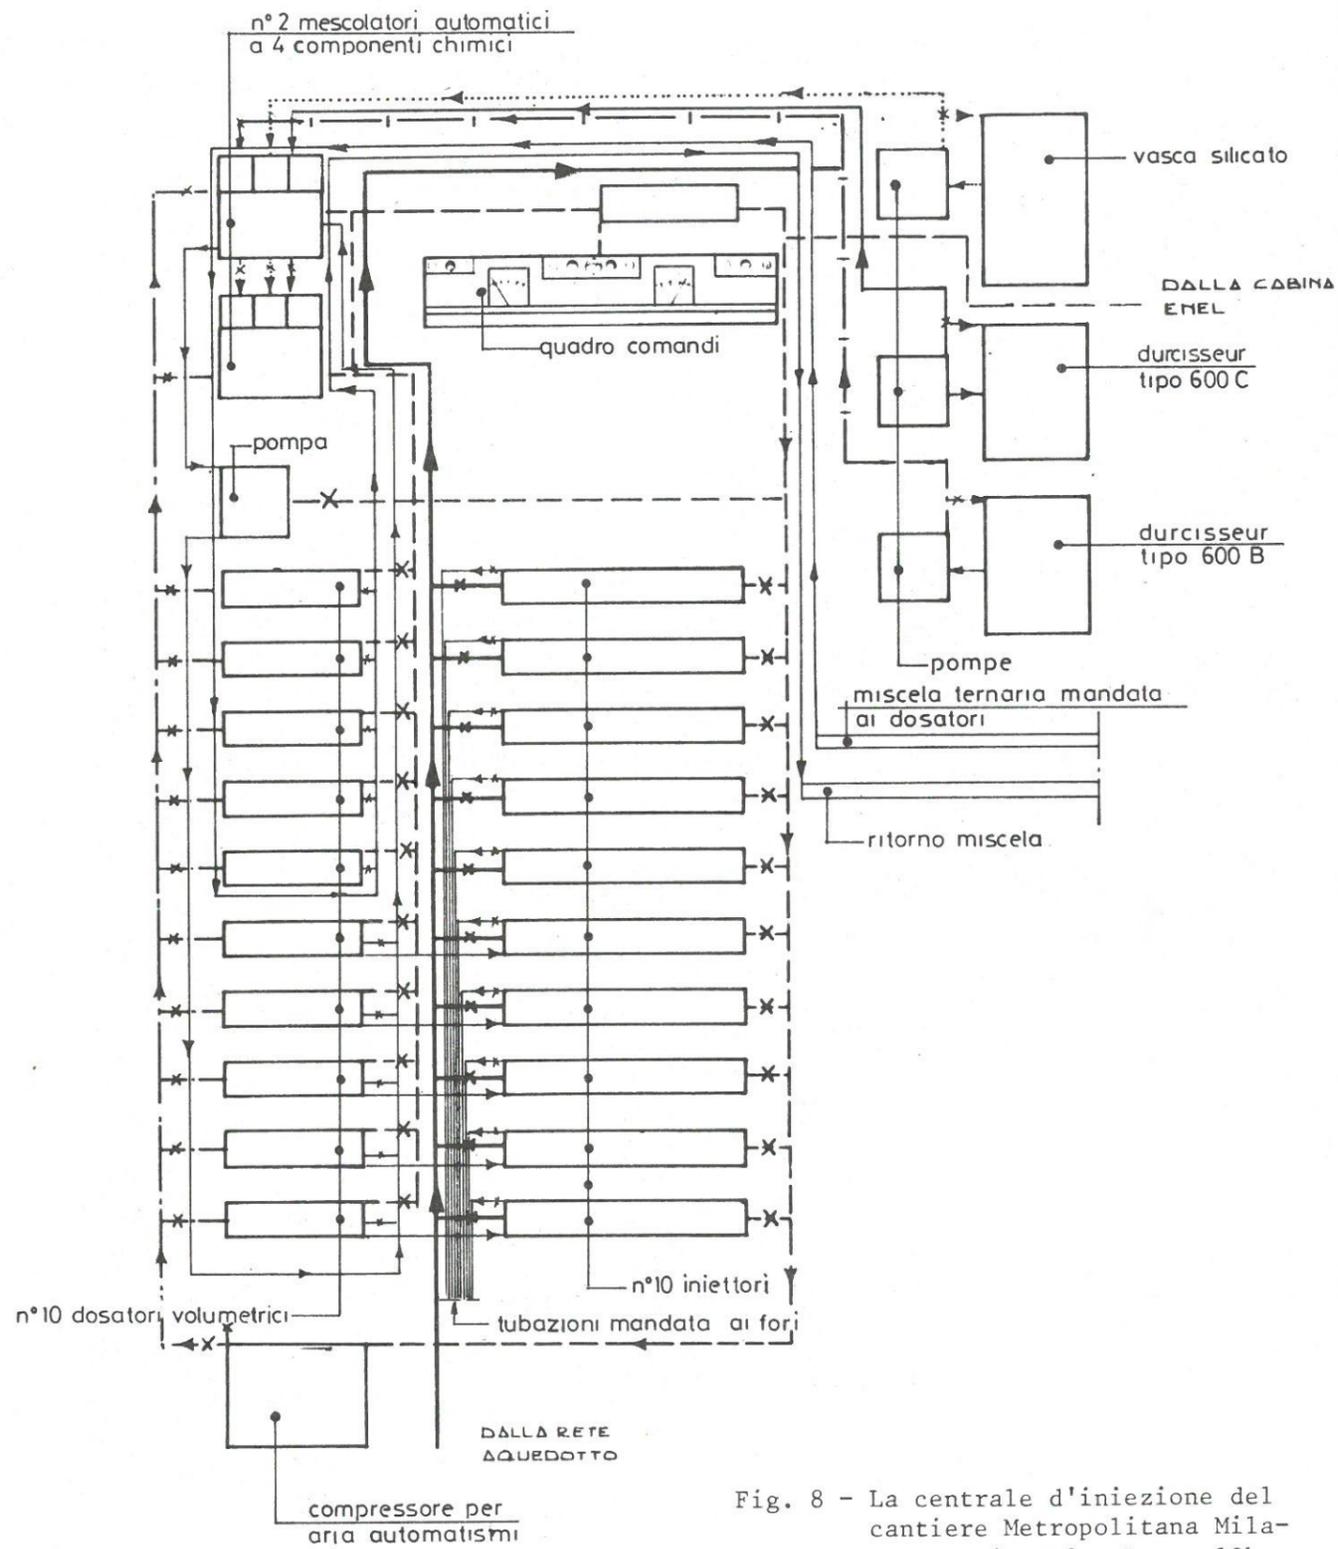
La centrale d'iniezione del cantiere Metropolitana Milanese - Linea 2 - Lotto 10b (Via Carducci).
